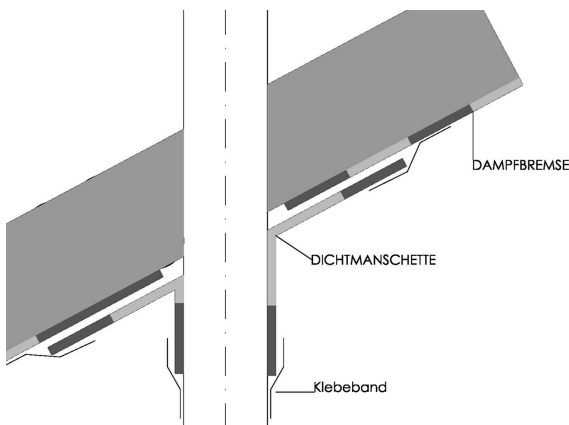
Richtige Ausführung Anschluss Dampfbremse an um gebende Bauteile bzw Rohrdurchführungen
